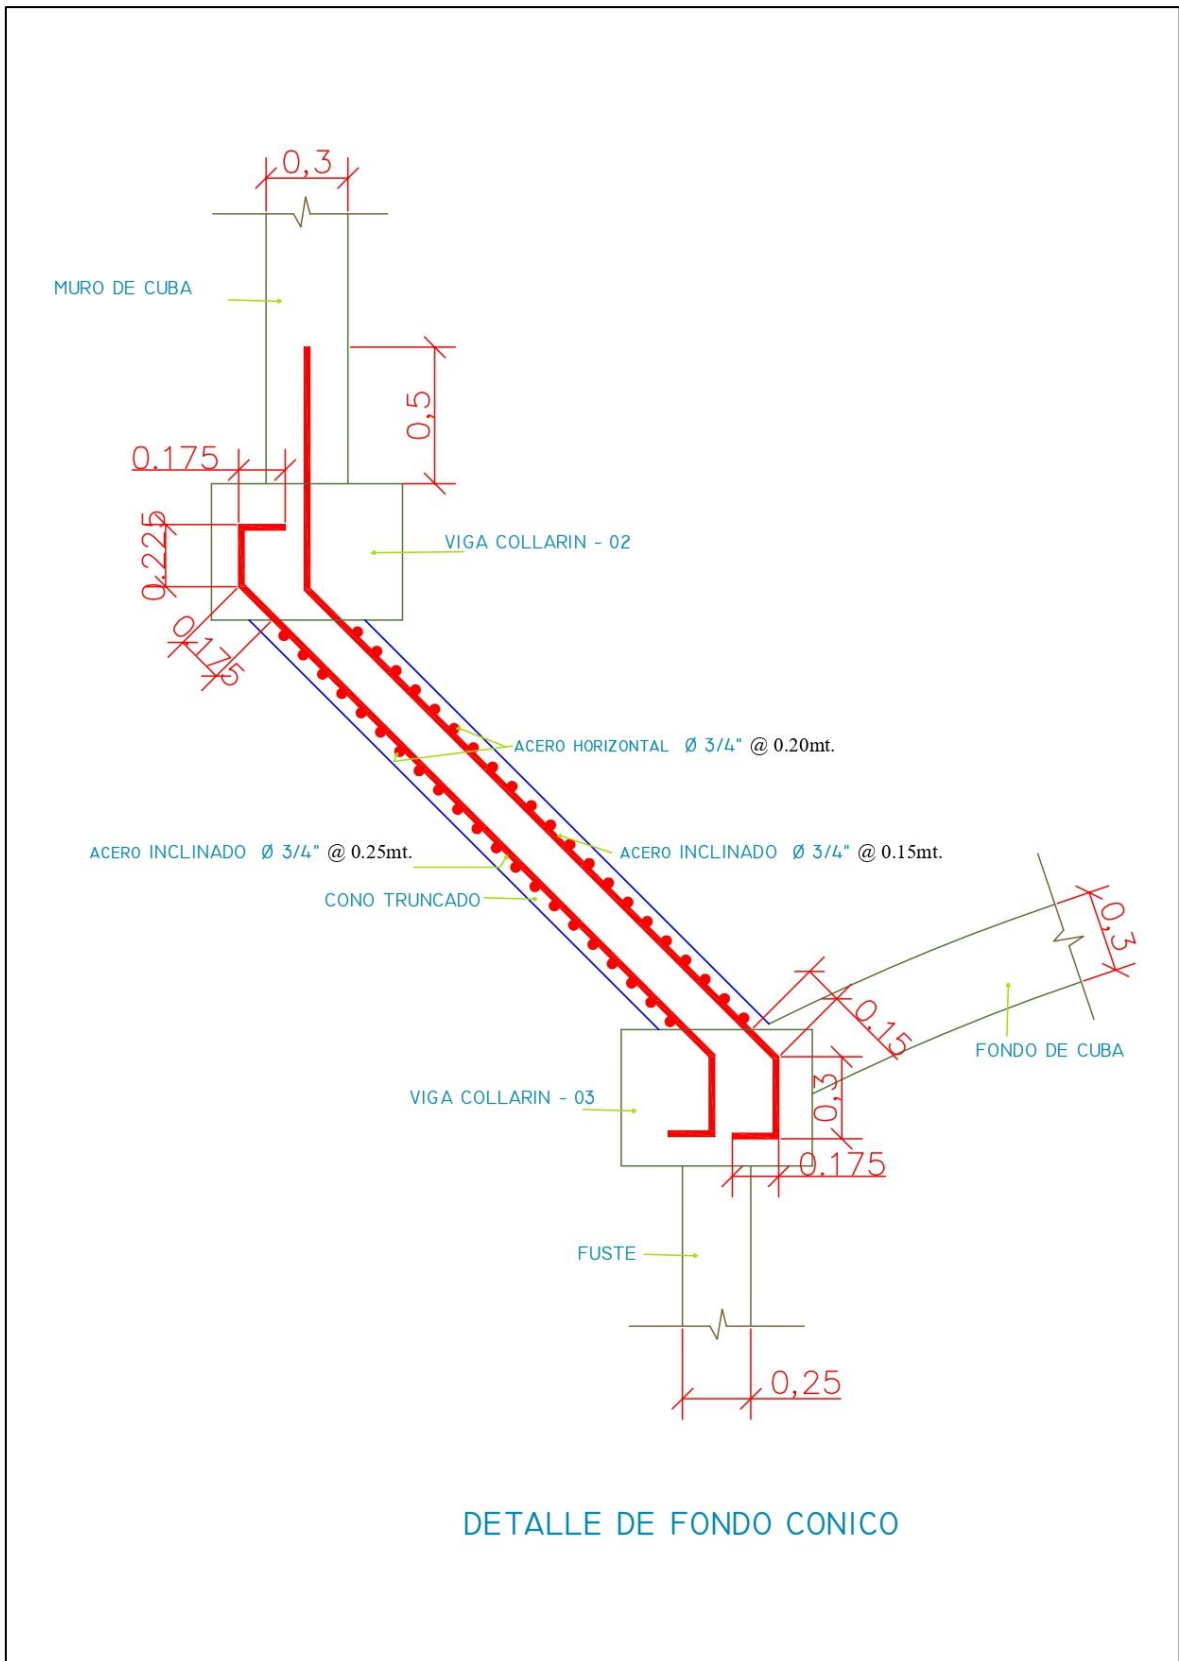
Plano de detalle de distribución de acero en fondo cónico.
